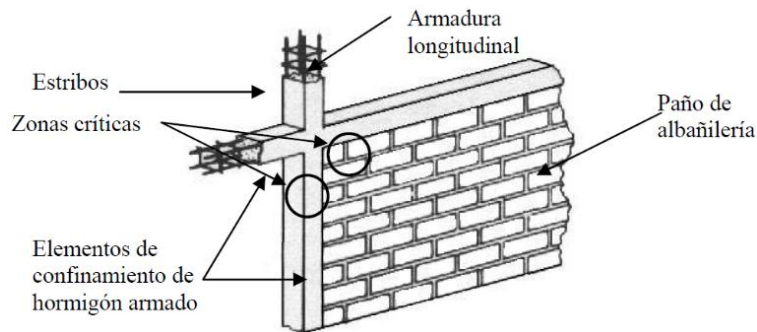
Muro confinado. Fuente: Astroza & Schmidt (2004)
